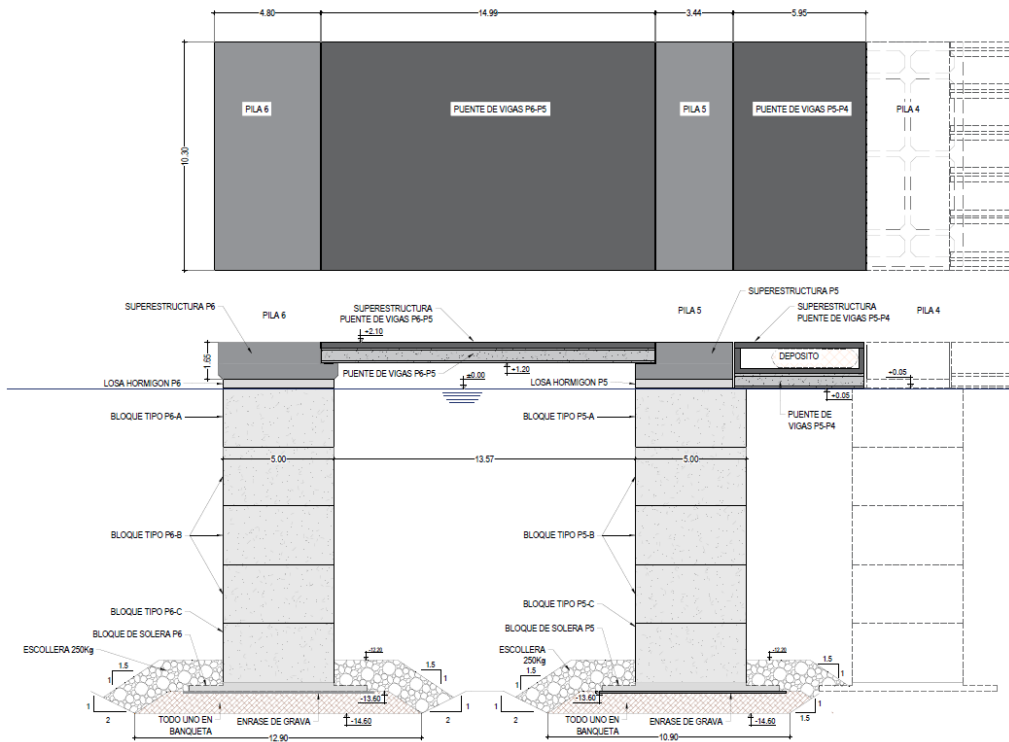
Planta y alzado propuesta de restitución para las pilas P5 y P6.
